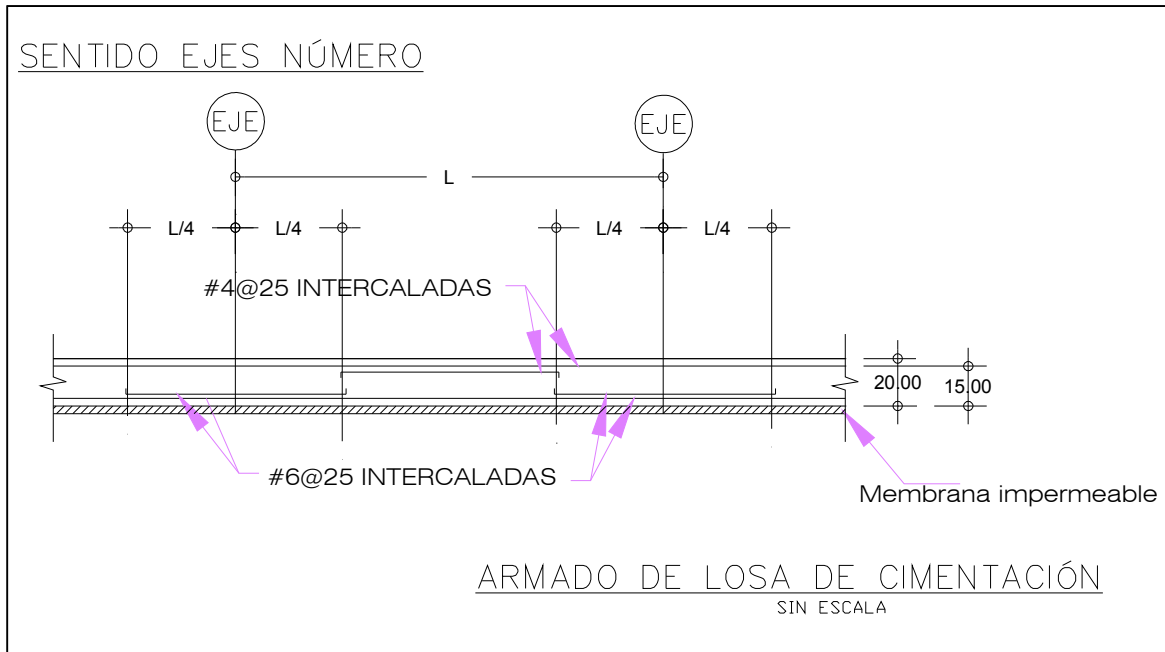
10 Detalle armado de losa en sentido de ejes número.
